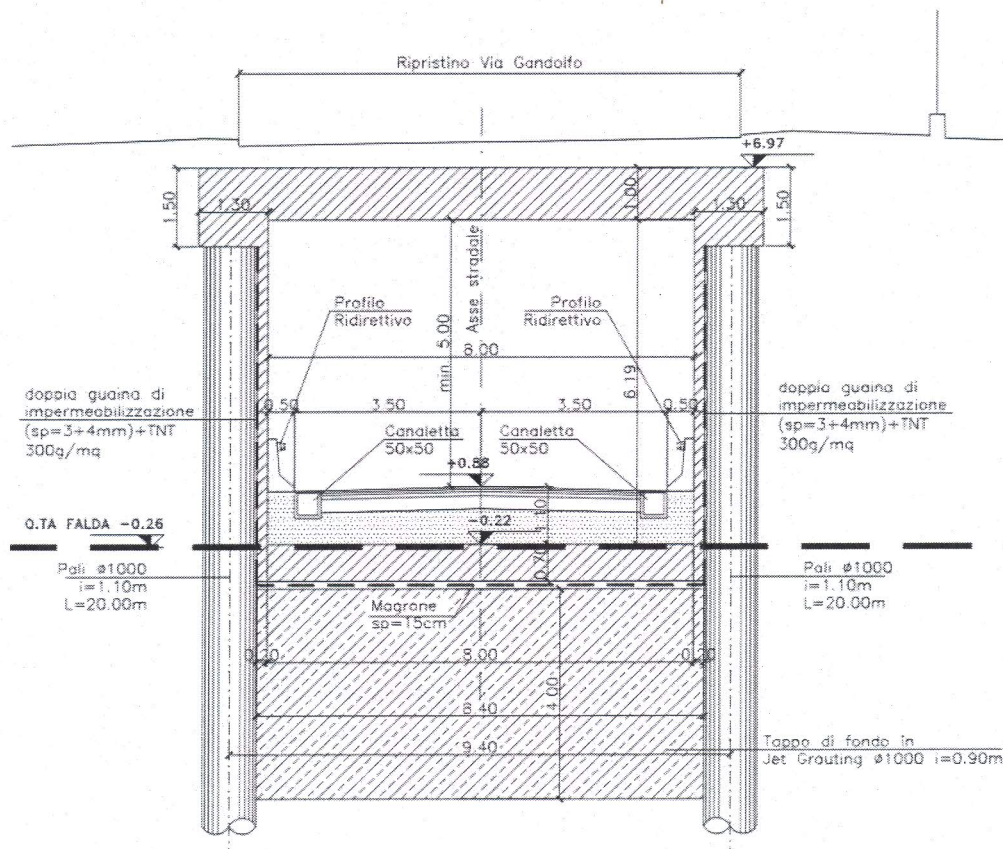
Sezione trasversale sottovia “Metodo Milano”
